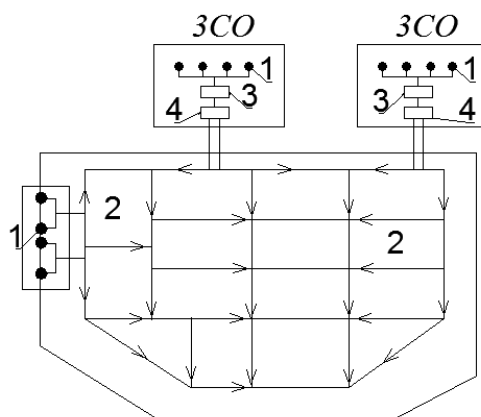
Общая схема артезианского водопровода: 1– скважина; 2 – сеть водоснабжения; 3 – резервуары; 4 – насосная станция 2-го подъема; ЗСО – зона санитарной охраны.
